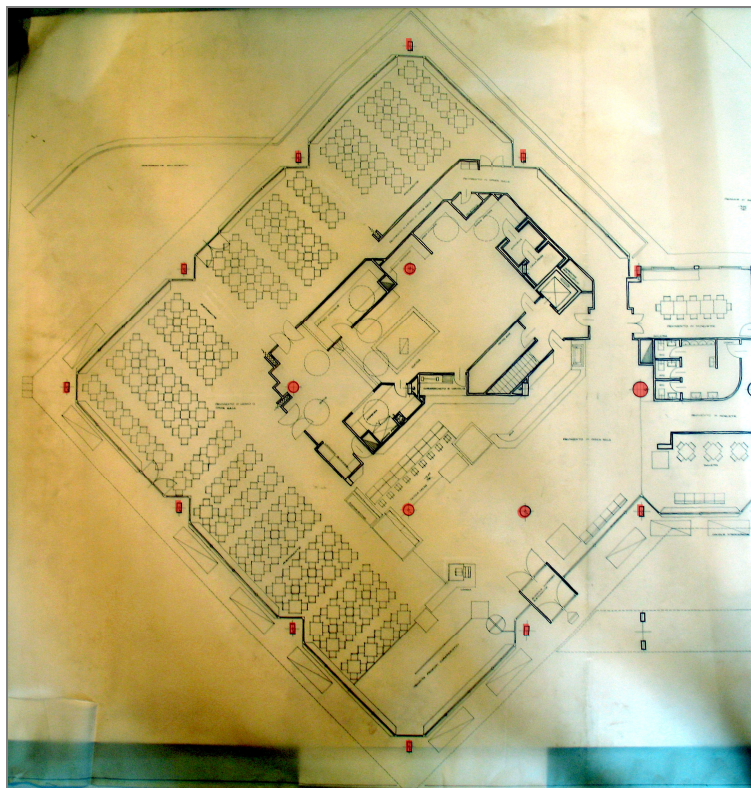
disposizione pilastri corpo C (fonte CSAC – stralcio tav. 38, archivio n. 161-1, rielaborazione f.m.)
